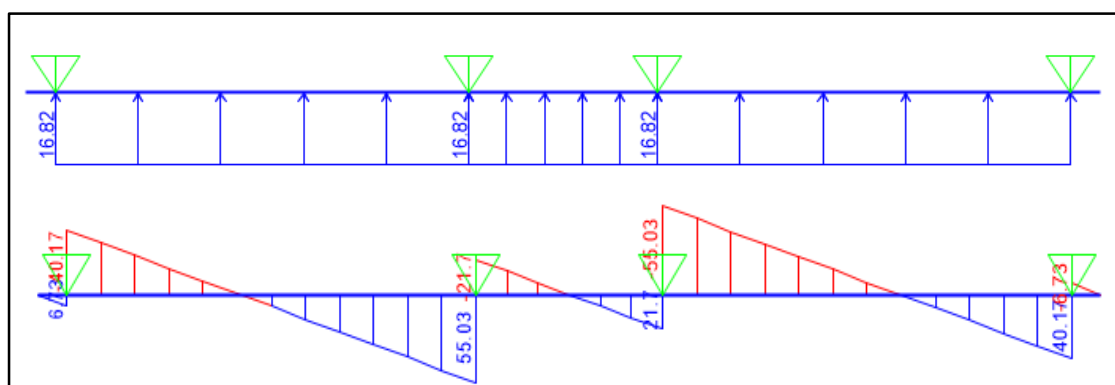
DFC de la losa - Zapata reticular sin viga de cimentación - Sistema dual tipo I
